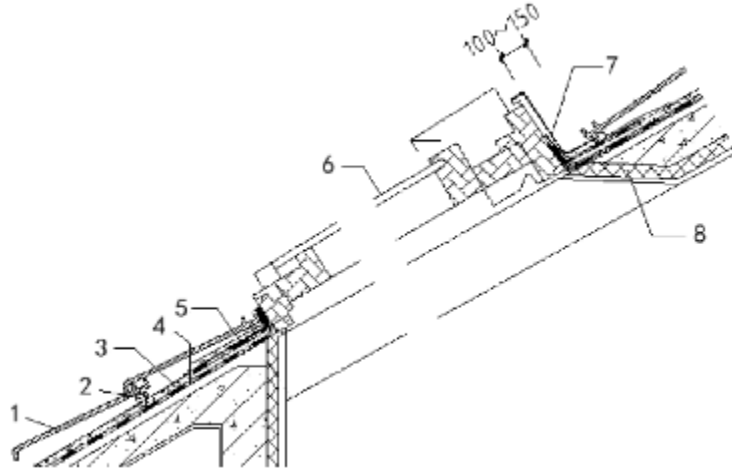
烧结瓦、混凝土瓦屋面屋顶窗防水构造
